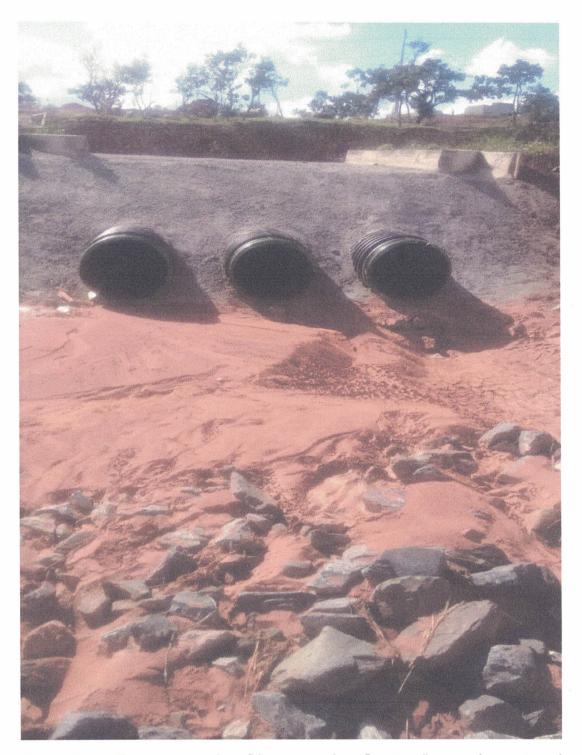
Descarga do Sistema de Captação a jusante do rio Taboquinha.
